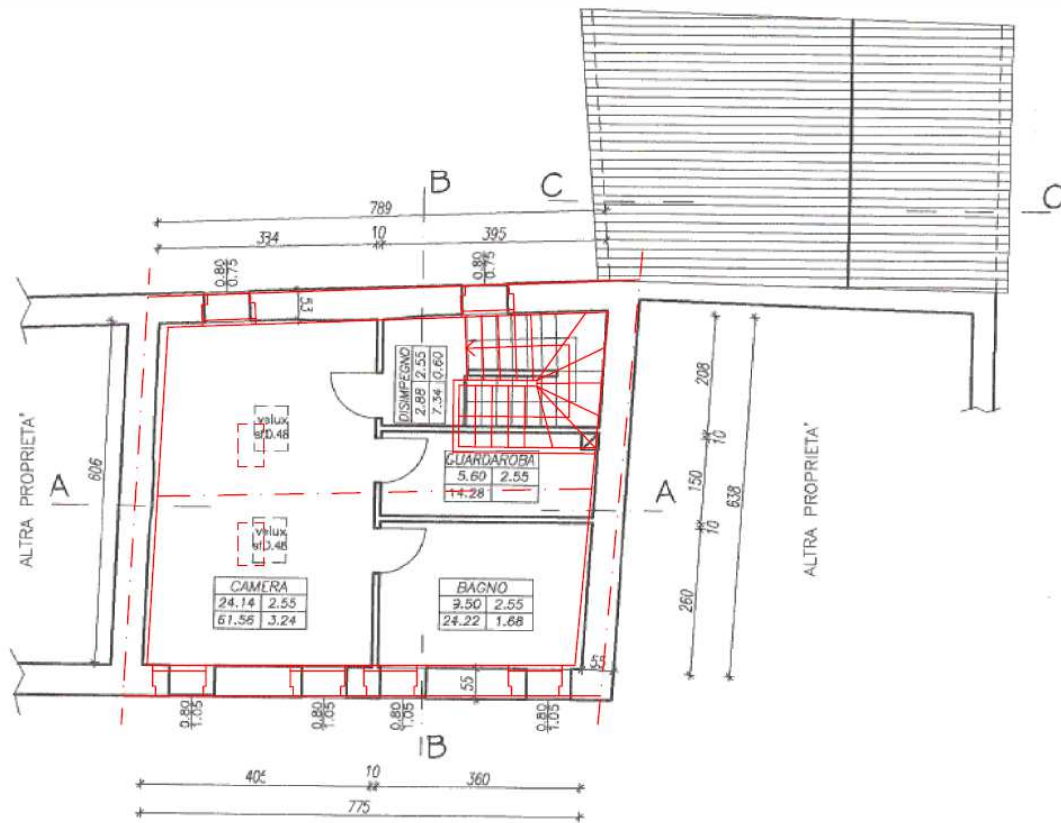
Comparazione stato attuale – stato approvato – piano secondo.
